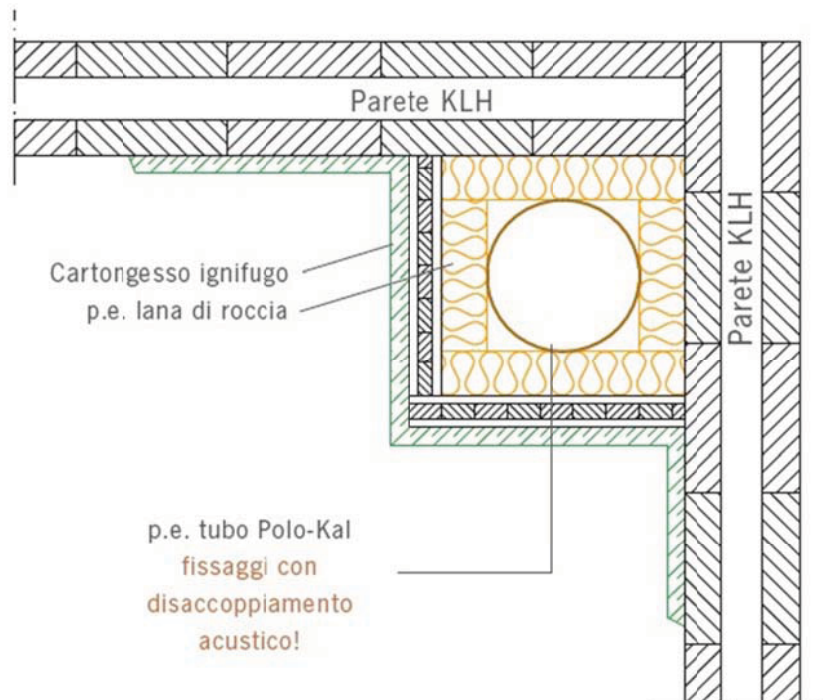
Schema in pianta: cavedio impiantistico. ⁽²⁴⁾
